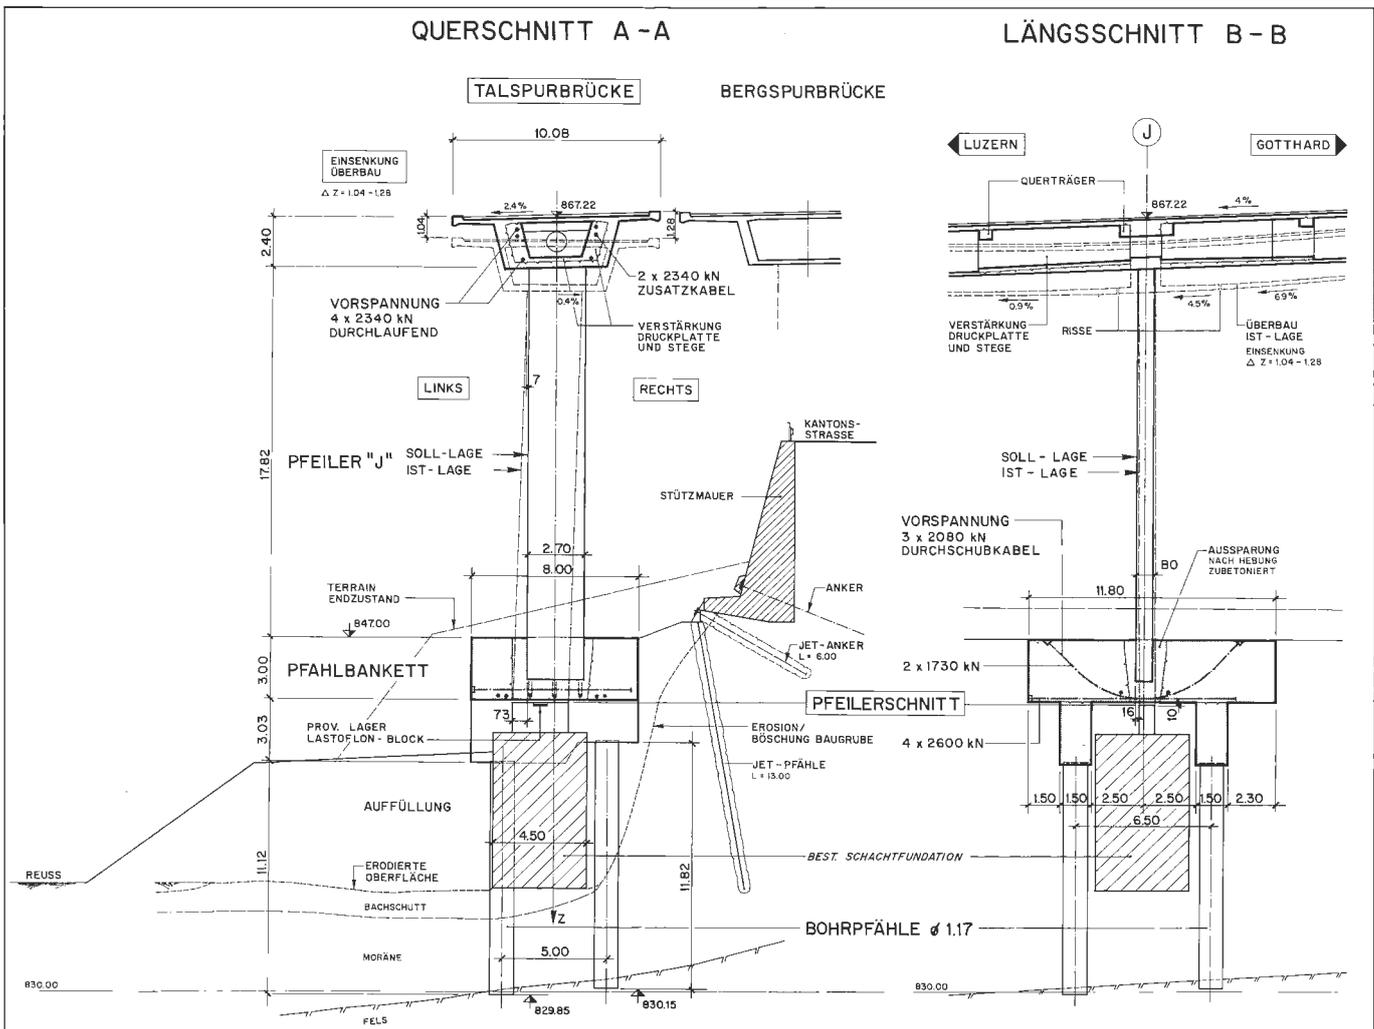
Quer- und Längsschnitt Foundation Pfeiler J
